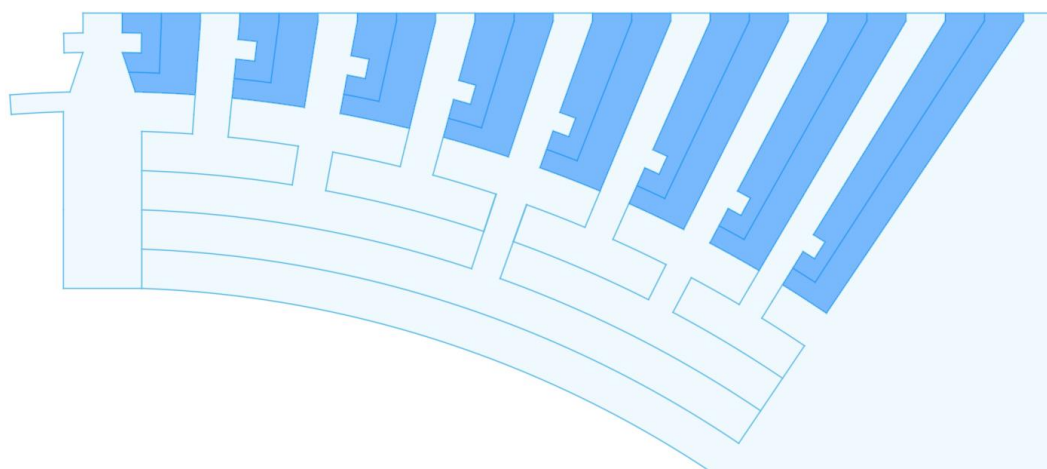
| Elaboración propia | solución de unión de las piezas de la estructura exterior
